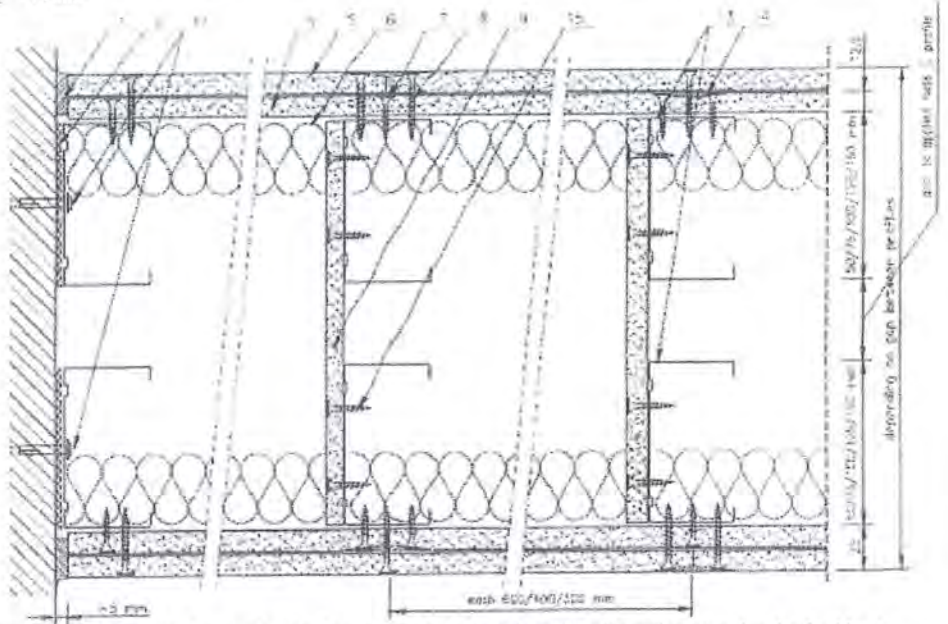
Vertikal- und Horizontalschnitt einbruchshemmender nichttragender zweilagiger Trennwände mit doppeltem Ständerwerk mit Laschen kraftschlüssig verbunden und zweilagiger Bekleidung - für Installationswände
